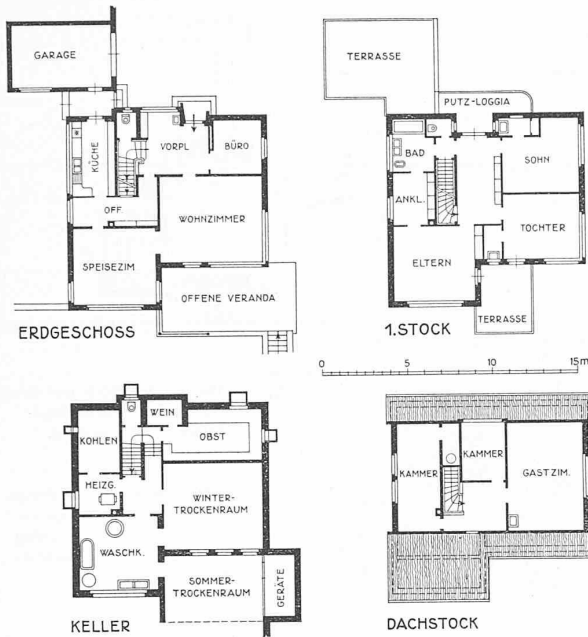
Grundrisse des Wohnhauses P. Deuss. — Masstab 1:400.
